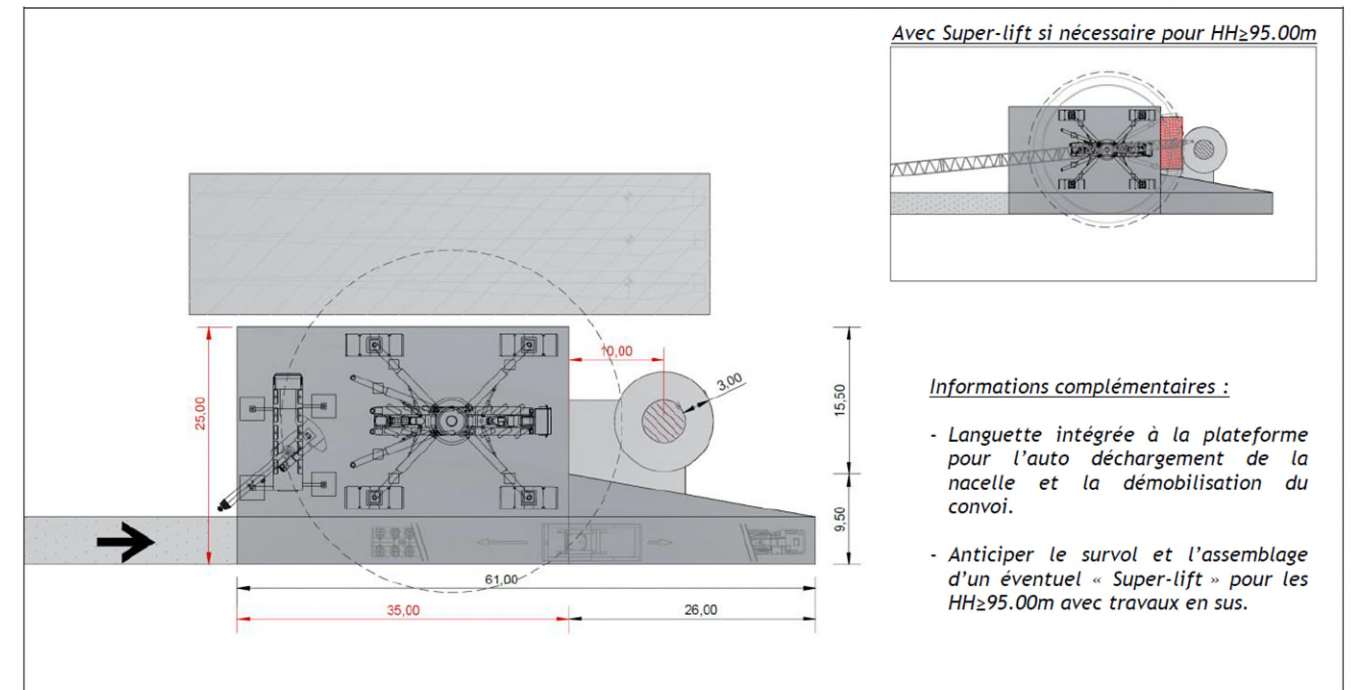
Plateforme en bout de piste avec languette de déchargement
